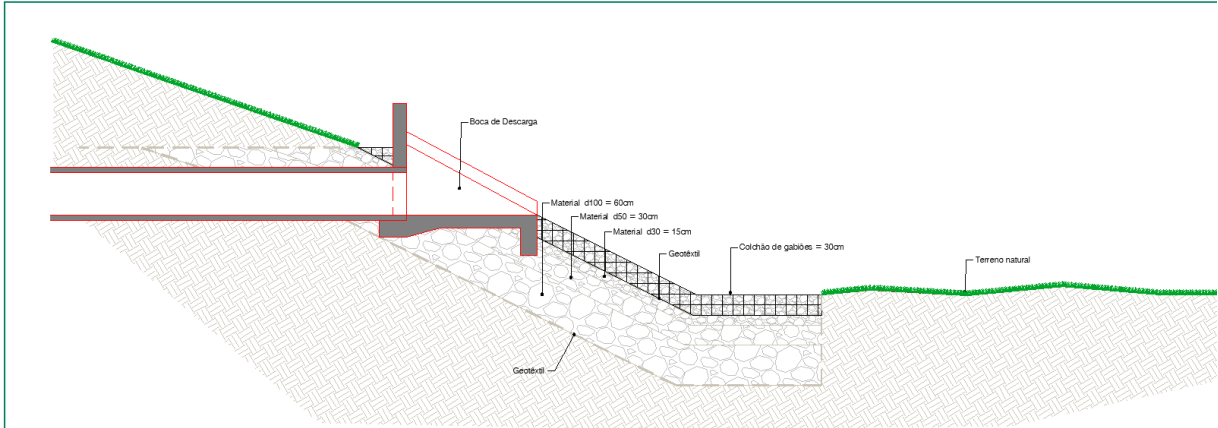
Pormenorização da Descarga de água pluviais nas bacias de infiltração
